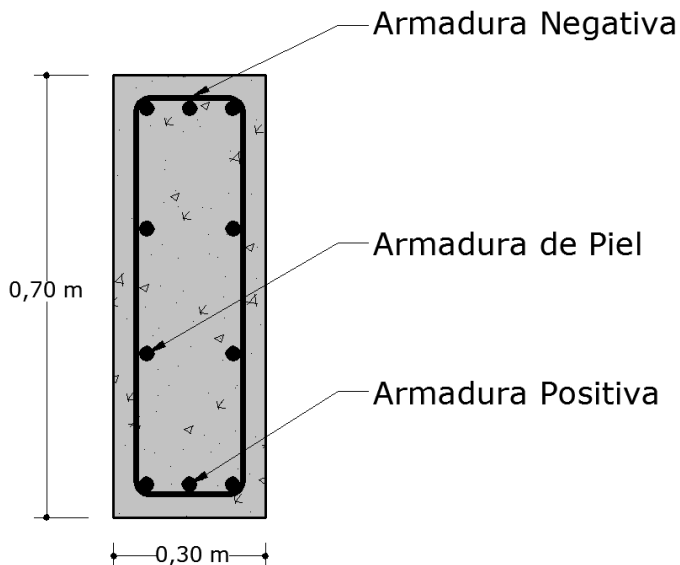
Dimensiones de la viga, Elaboración Propia
